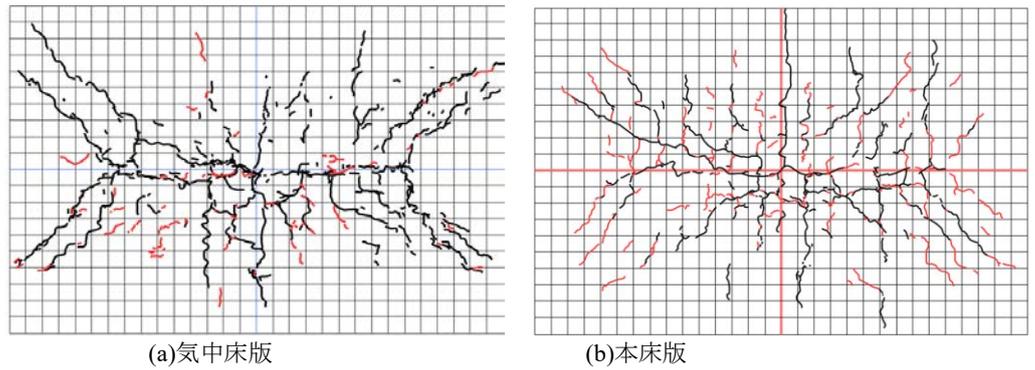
床版下面のひび割れ状況(走行回数 15 万回)
